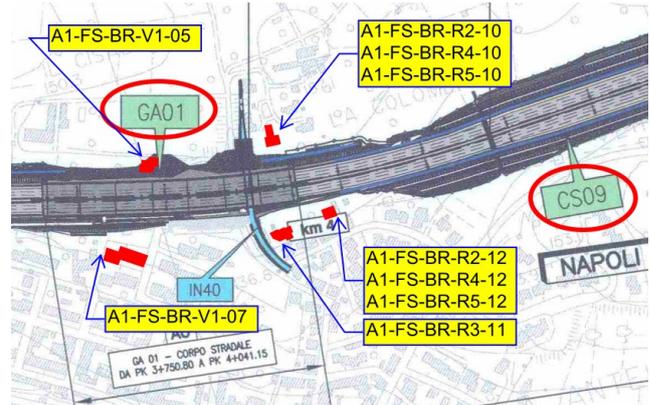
Stralcio della planimetria allegata al PMA con la posizione dei WBS GA01 e CS09 (attive).
